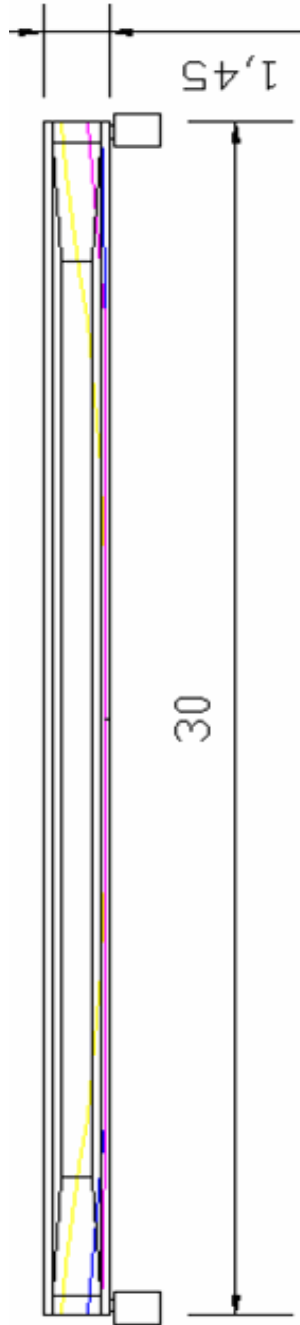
Cara Inferior de La Viga Transversal con la Plancha
